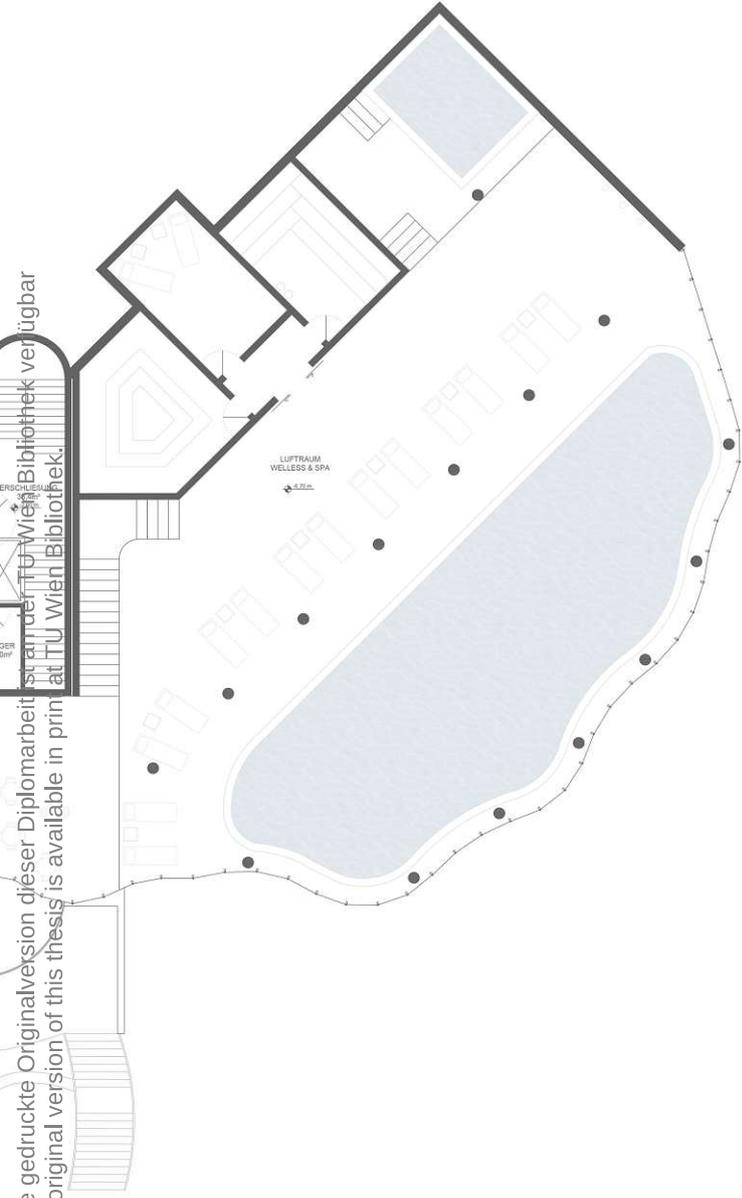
Grundriss 1. Untergeschoss
